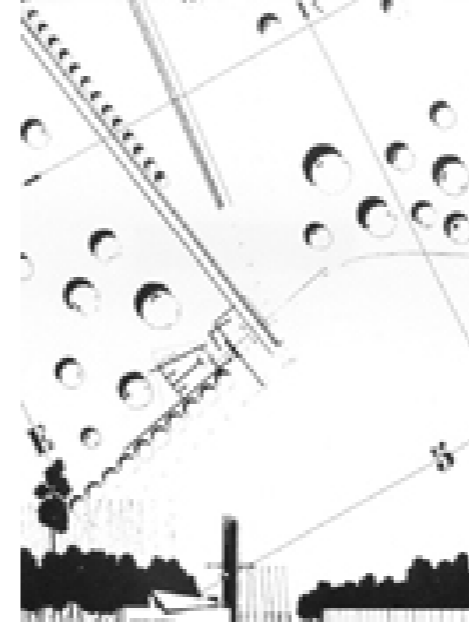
Parque Tarango 1988 acceso, planta y alzado
